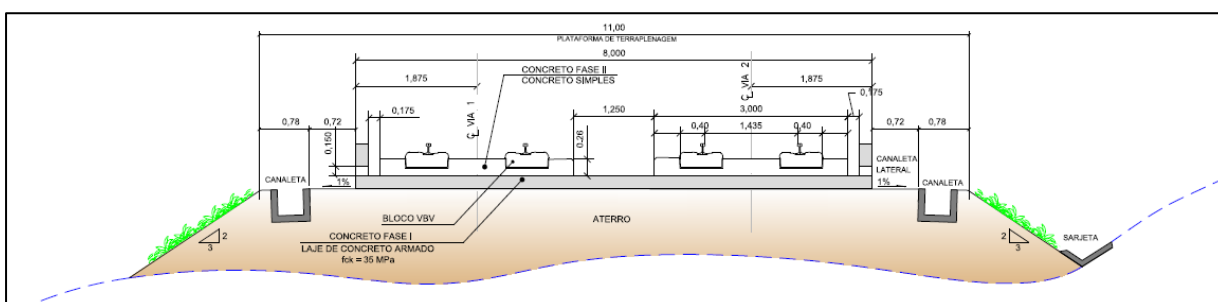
Seção transversal tipo – Detalhe Trecho em Aterro Superestrutura LVT
